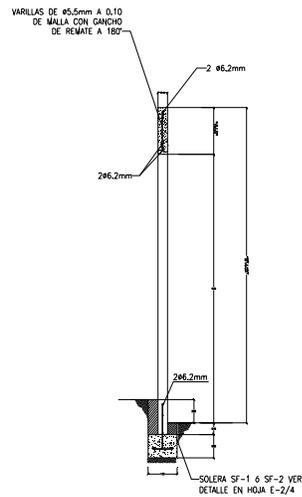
Detalle de solera de fundación y pared, para el sistema de paredes de concreto y panel remallado estructural
